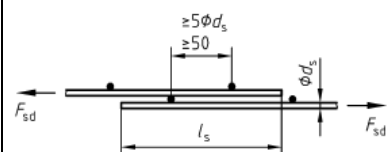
Übergreifungsstöße von geschweißten Betonstahlmatten
